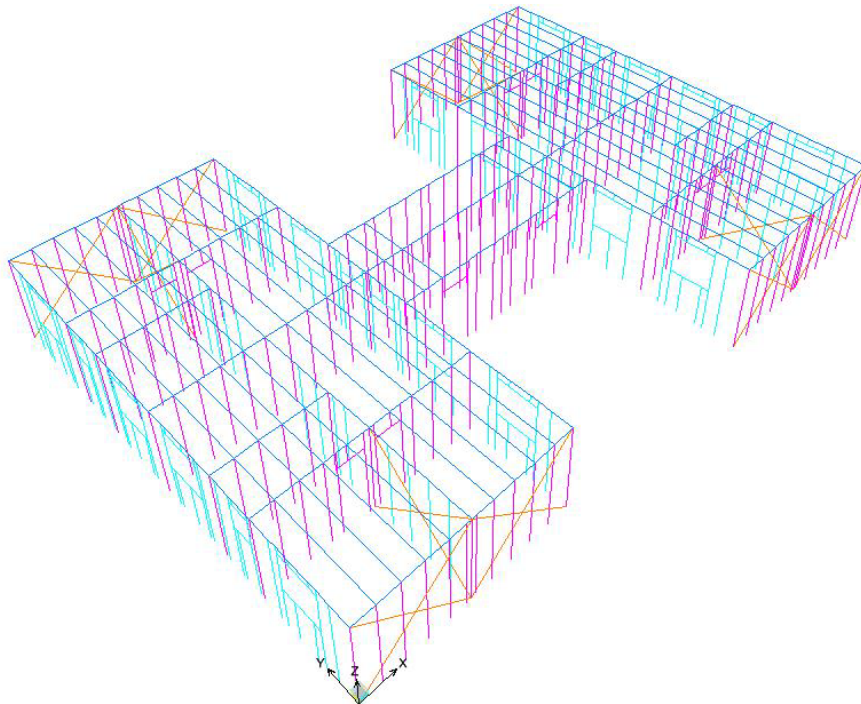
(a) – Modelo B-4-600-X-descont: pavimento-tipo unifilar (continua)
